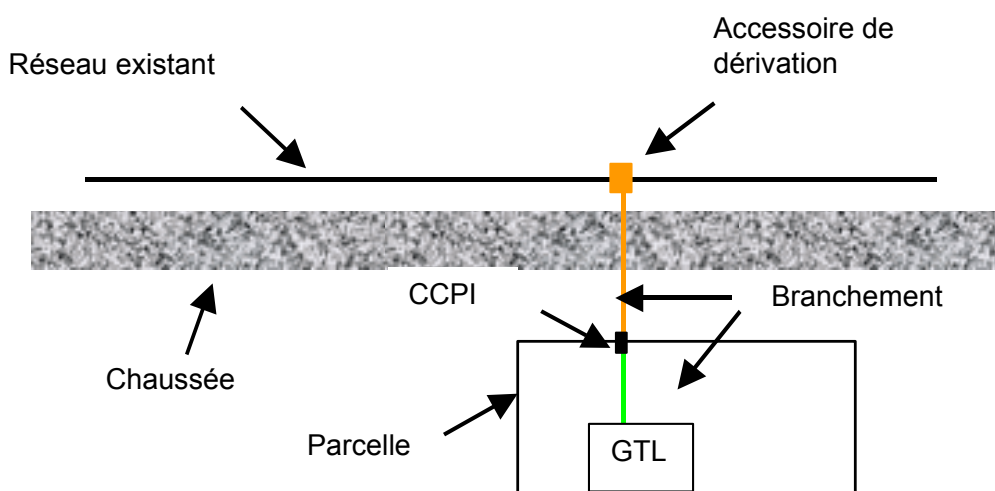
Raccordement individuel BT ≤ 36 kVA avec traversée de chaussée
